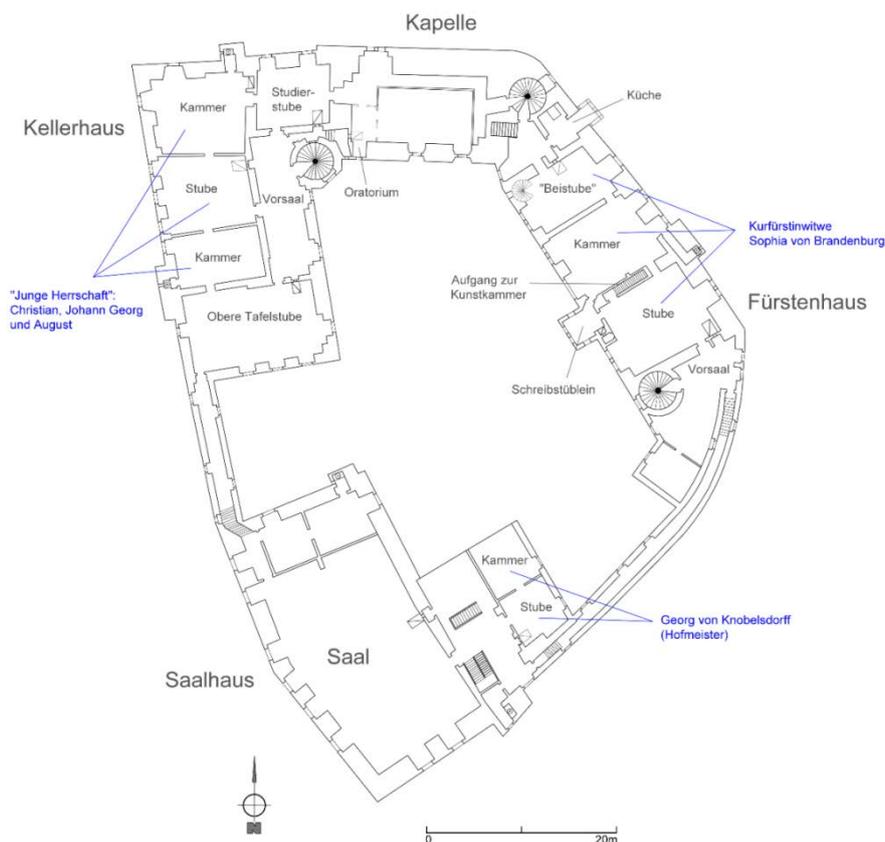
Schloss Colditz, Grundriss 2. Obergeschoss, Rekonstruktion der Raumstruktur 1597 (Christa Syrer, 2016)
